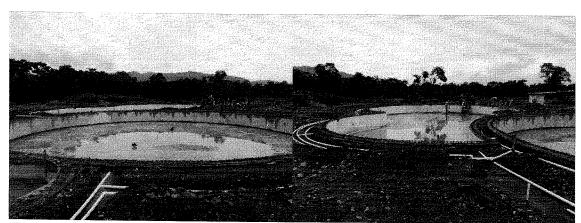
Detalle de las obras implementadas en el área ya intervenida con el aprovechamiento.
